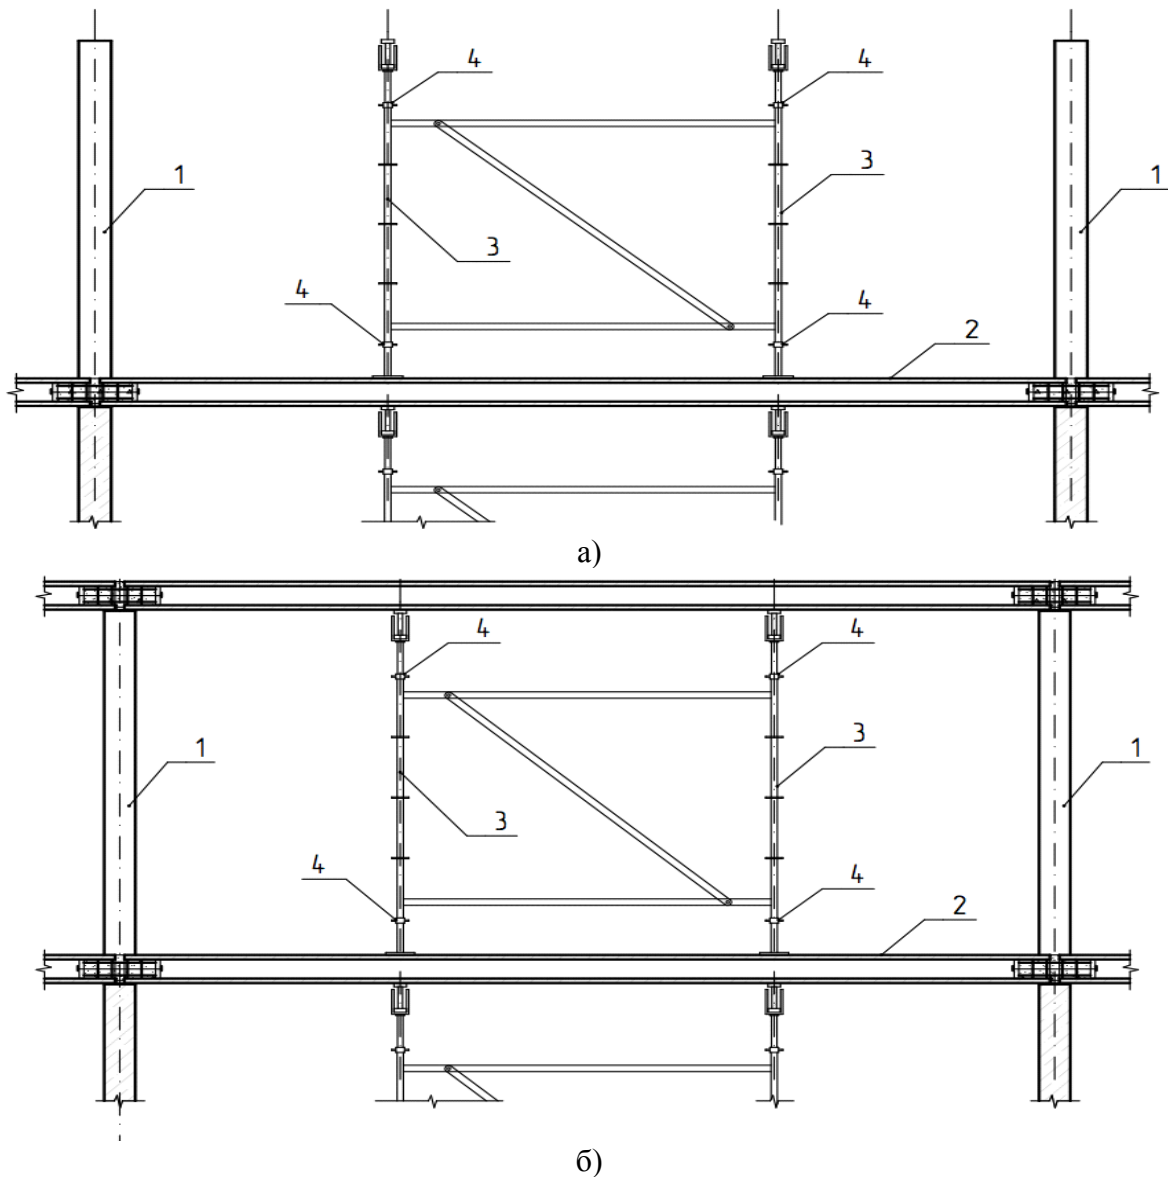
Установка сборных железобетонных плит перекрытия:
